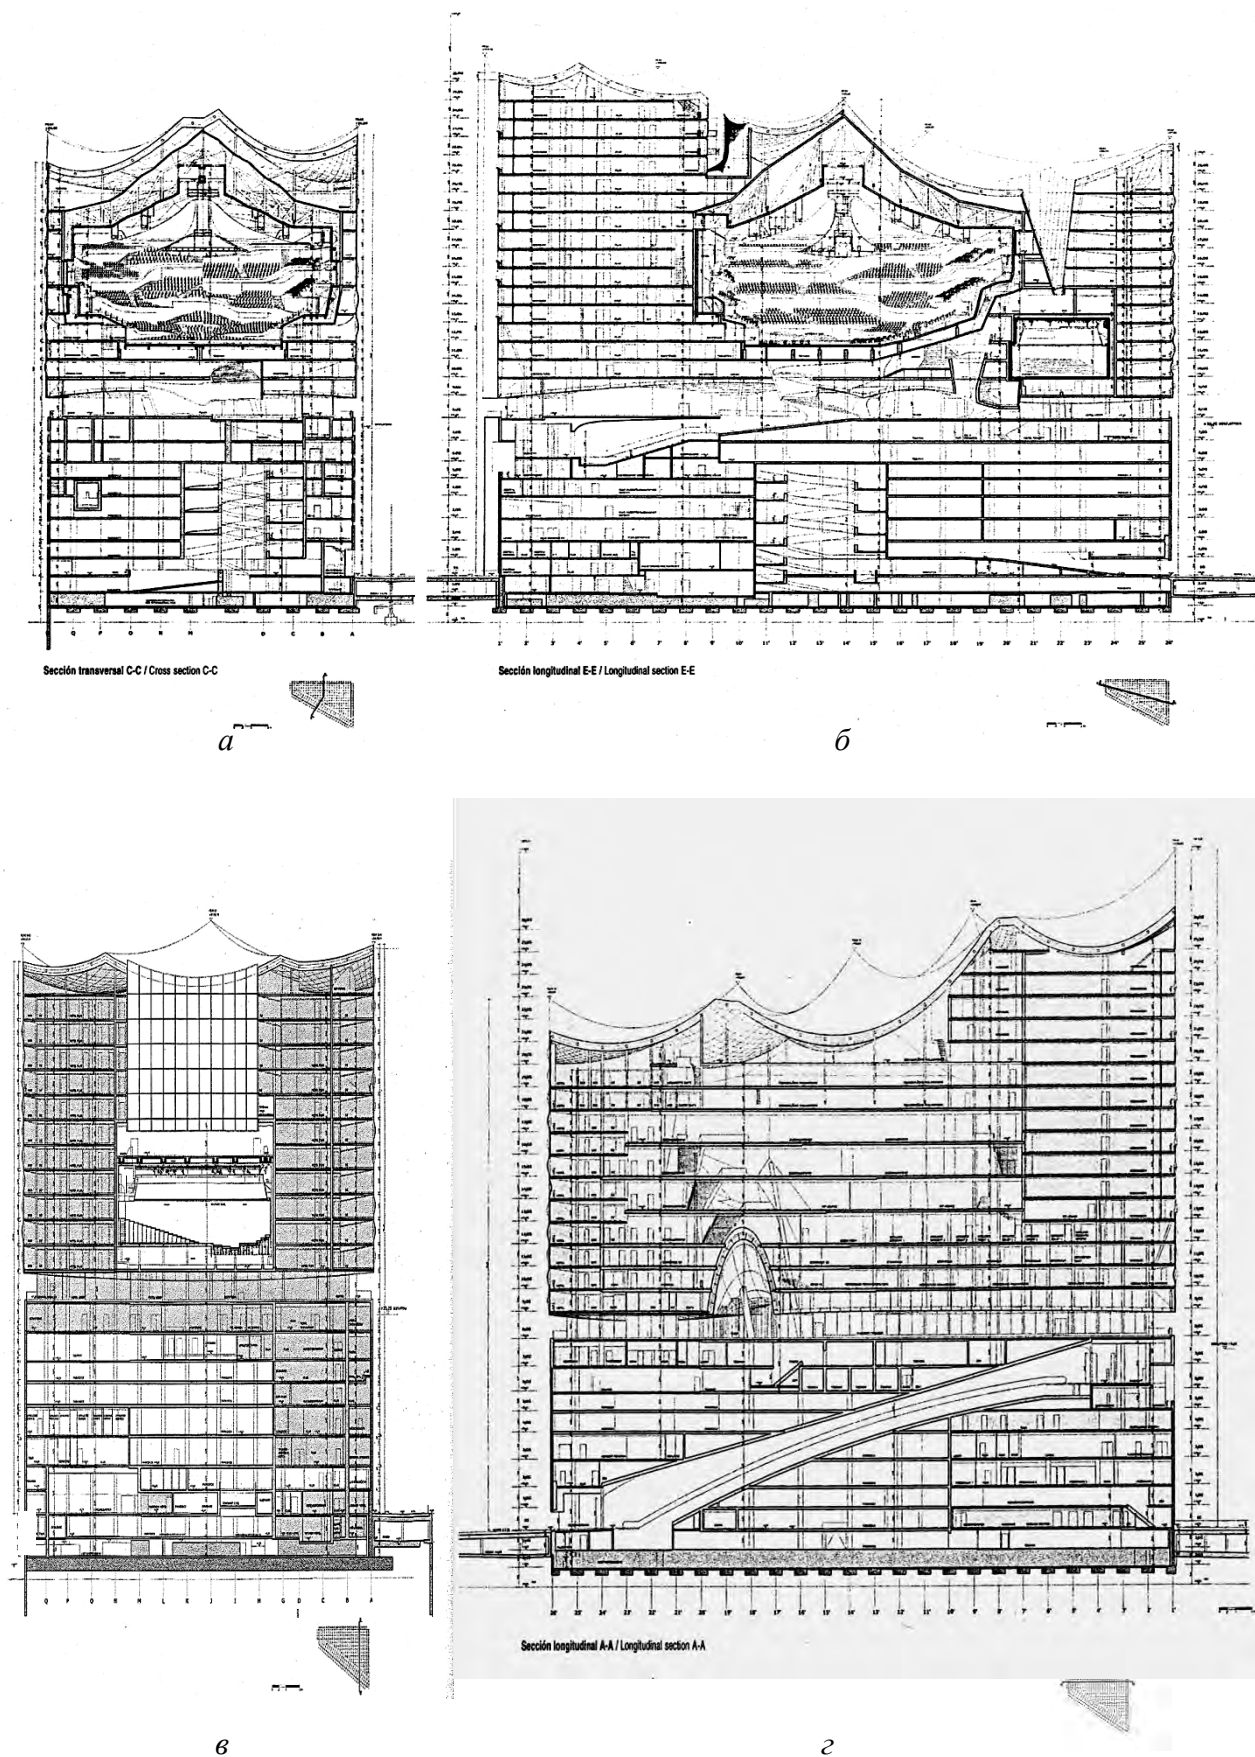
Разрезы: *a* – поперечный разрез по залу; *б* – продольный разрез по залу; *в* – поперечный разрез; *z* – продольный разрез по эскалатору
